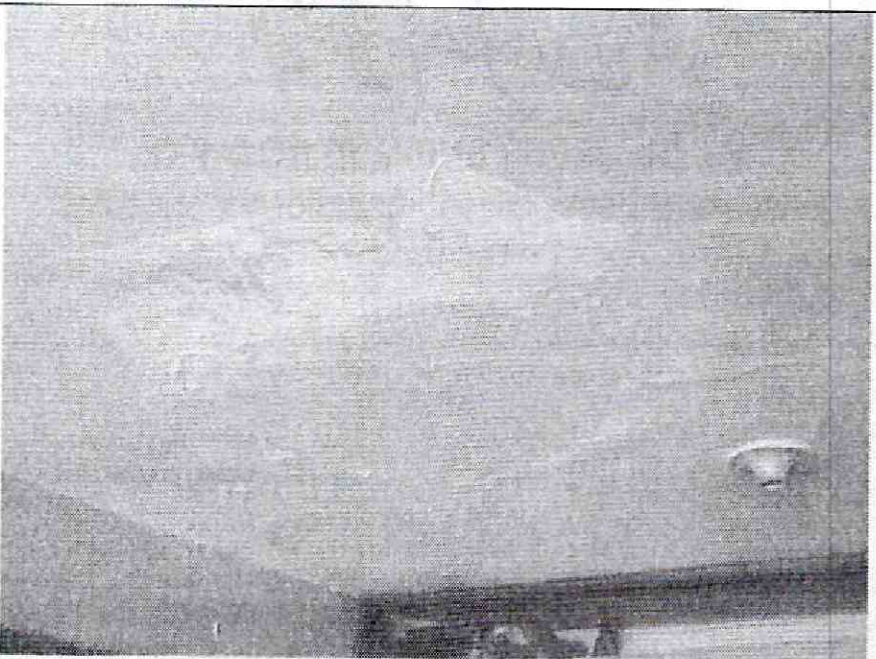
Daño por humedad en cielo raso bajo cubierta.
